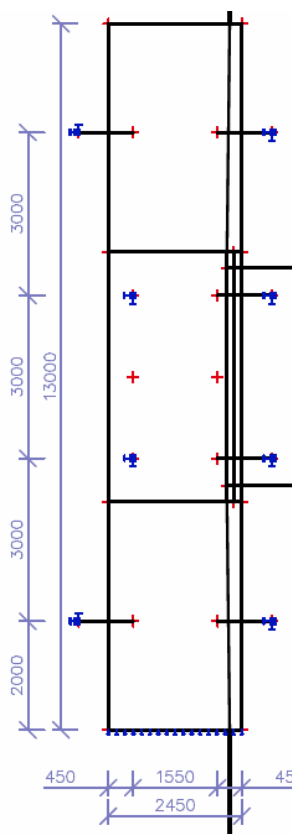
; Palenplan brug 7 (Schoorstand trekpalen 1:6)
